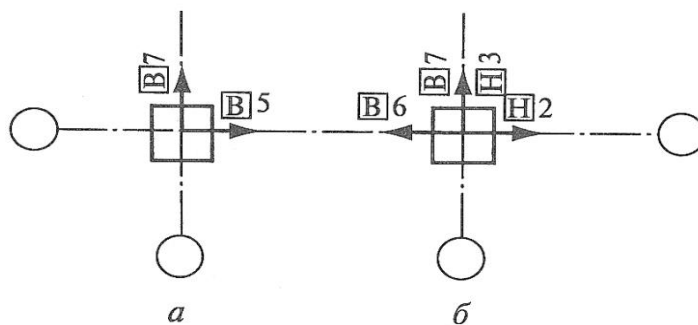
Примеры указания действительных отклонений осей элементов от разбивочных осей на плане для свай (а) и колонн (б)
